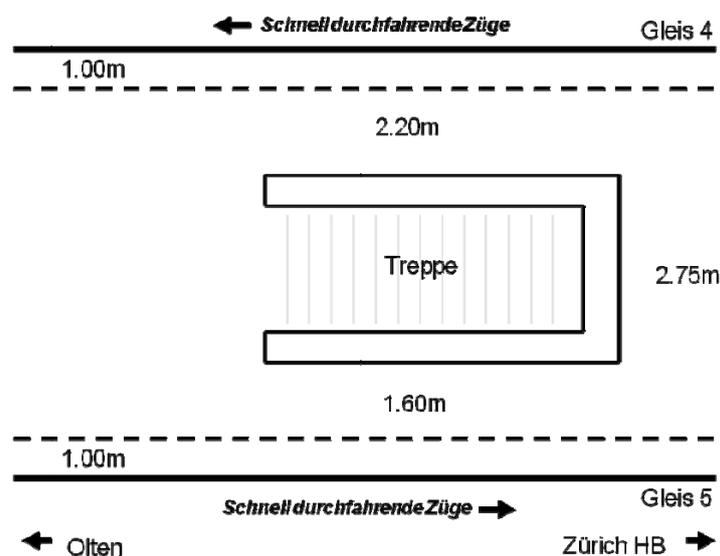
Grundriss Situation Aarau Gleis 4/5
